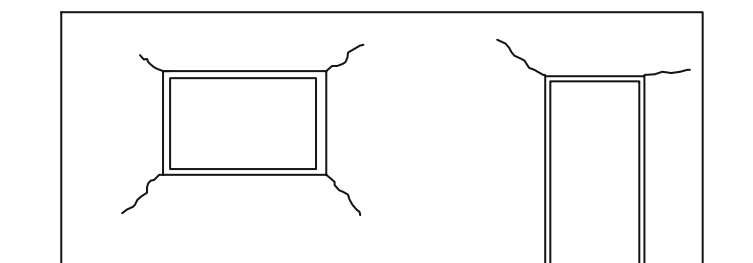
fissuração real em torno de aberturas em parede submetida a sobrecarga (THOMAZ, 1989)
